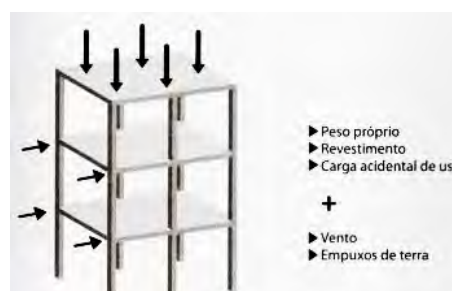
Carregamentos horizontais e verticais em estruturas. Fonte: KIMURA (2018)
